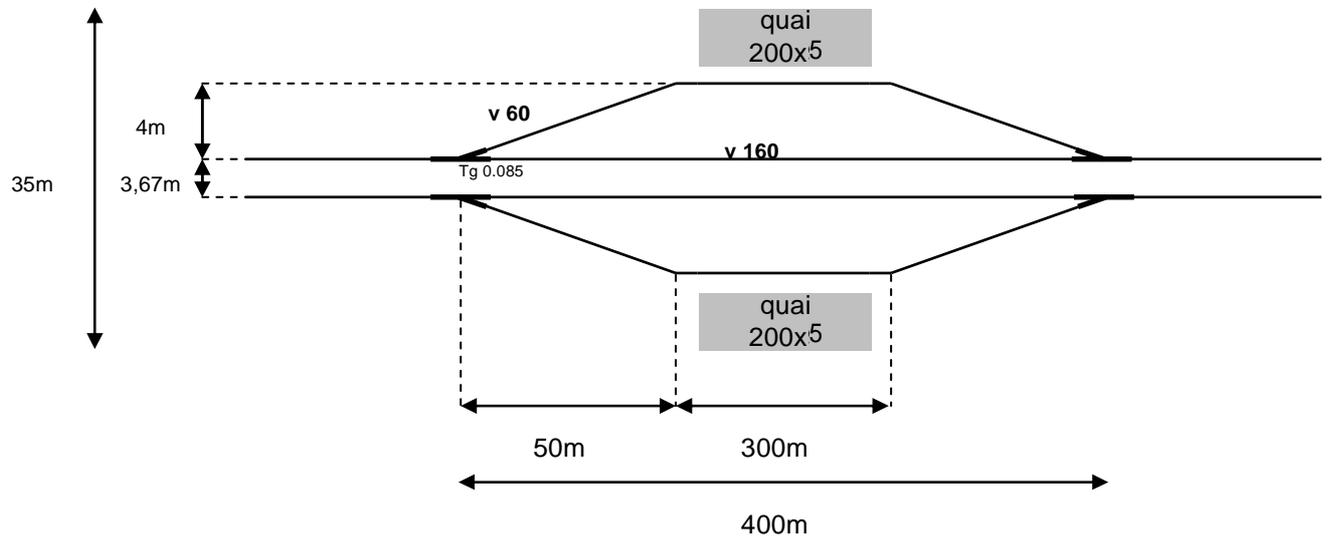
Plan de voies proposé pour la gare TER - variante 1
